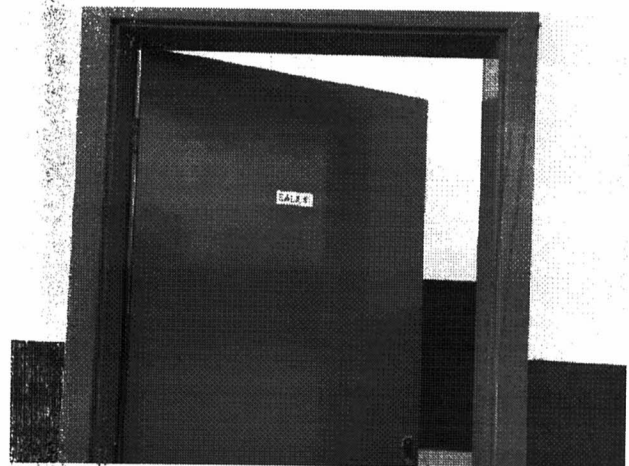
Vista parcial da porta de prancheta pintada e etiquetada
